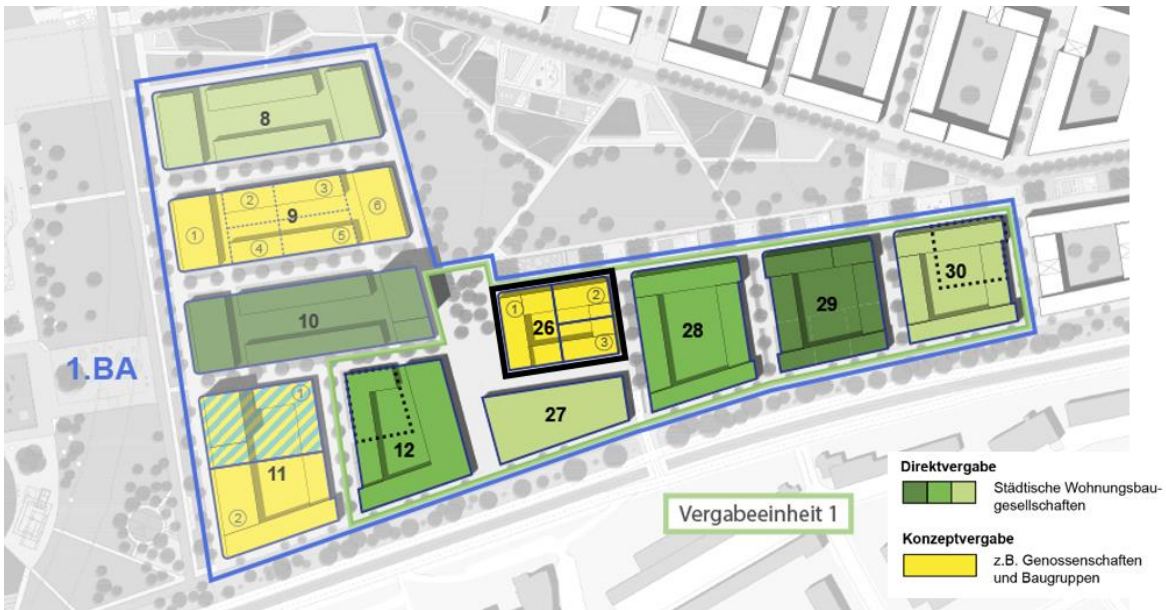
Lageplan 1. Bauabschnitt mit Vergabeeinheiten, Baufeld 26 schwarz markiert © Tegel Projekt GmbH
